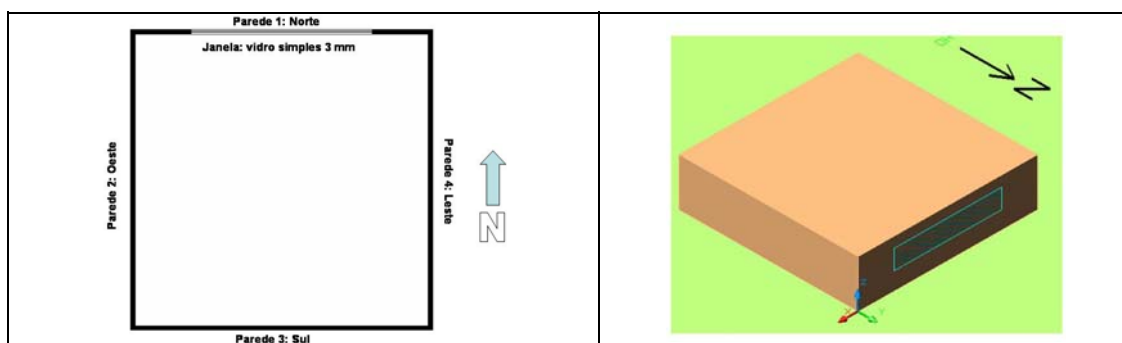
Planta baixa e perspectiva do modelo de edificação utilizado nas simulações
